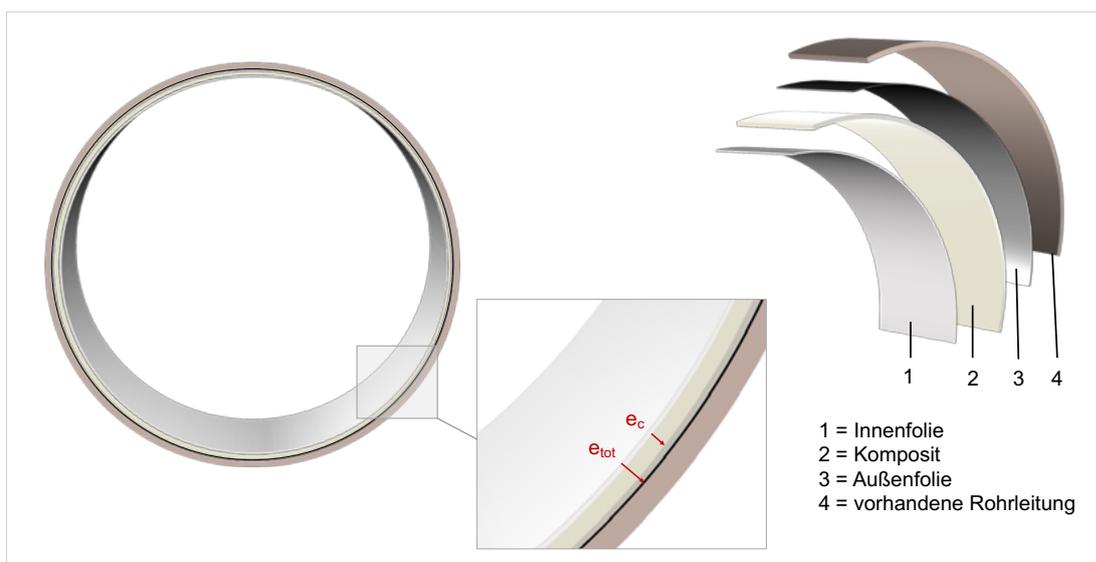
Typische Wandkonstruktion eines Druckschlauchs
